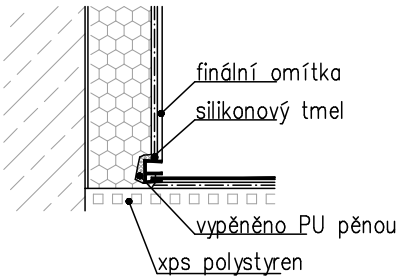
DETAIL BOČNÍHO UCHYCENÍ PARAPETU
